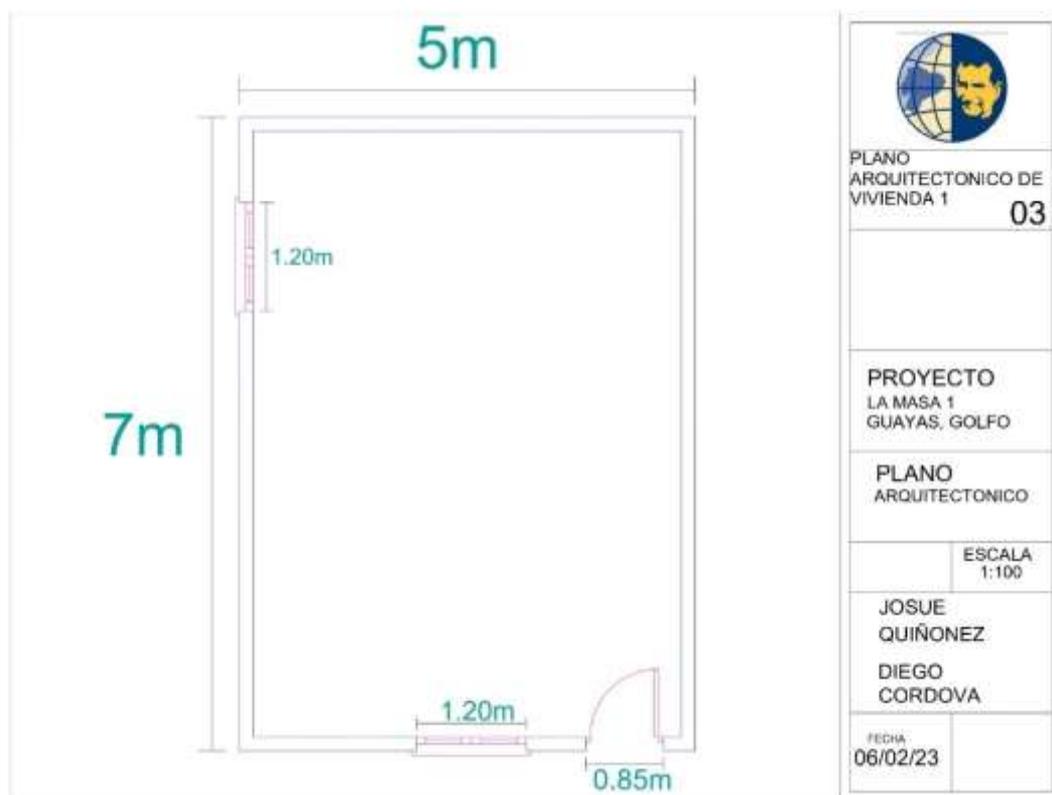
Plano arquitectónico en AutoCAD de la vivienda beneficiada.
